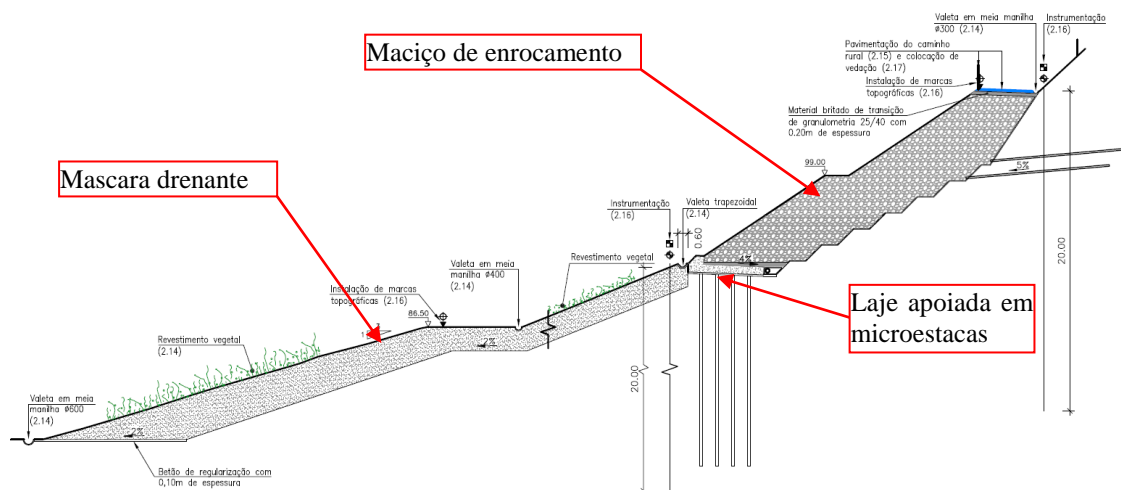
Maciço de enrocamento assente sobre laje, em betão armado fundada em microestacas.
